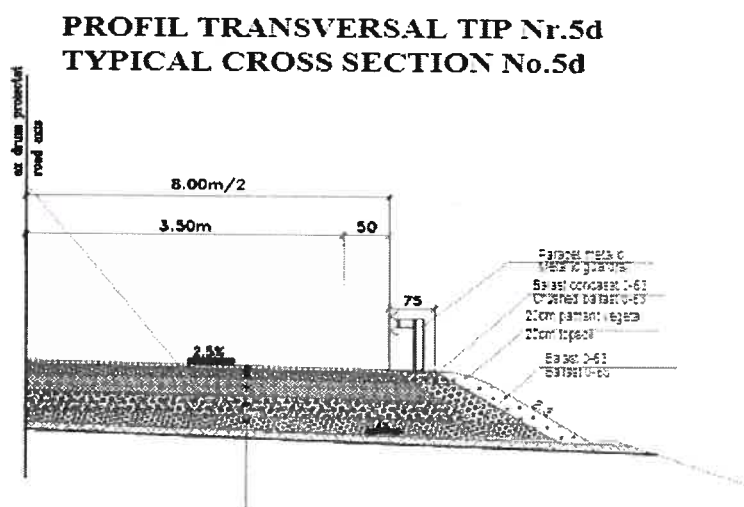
Profil transversal tip nr.5d - structură carosabilă nouă
